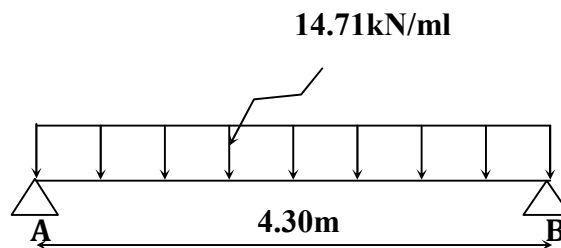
Schéma statique de la poutre de chaînage à l'ELU.
